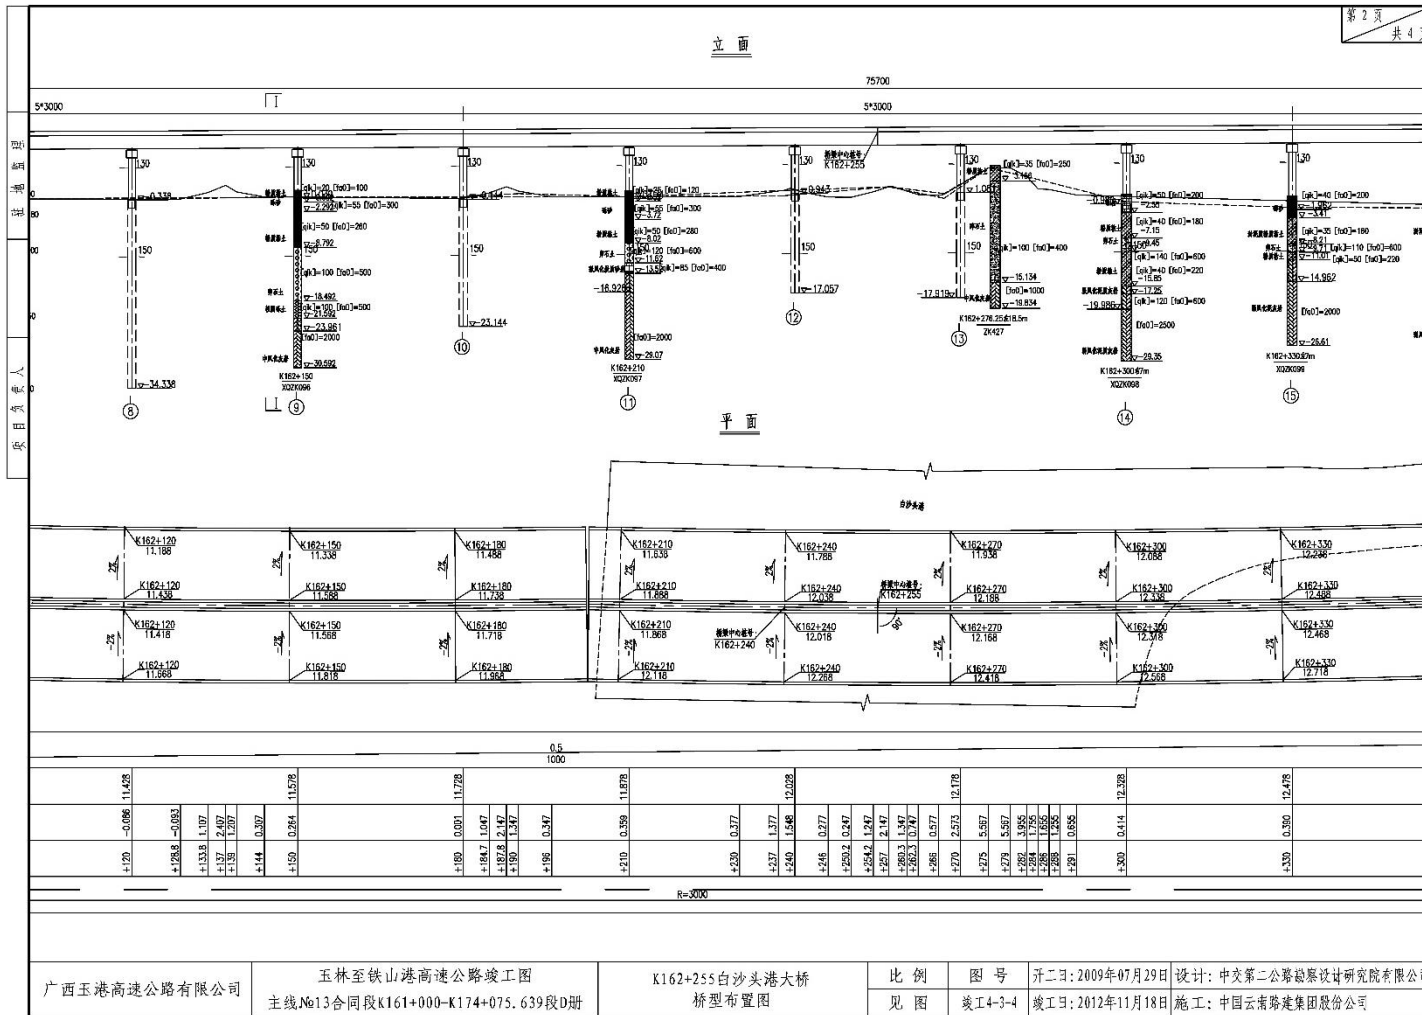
(2) 白沙头港大桥总平面布置图-分幅 2
